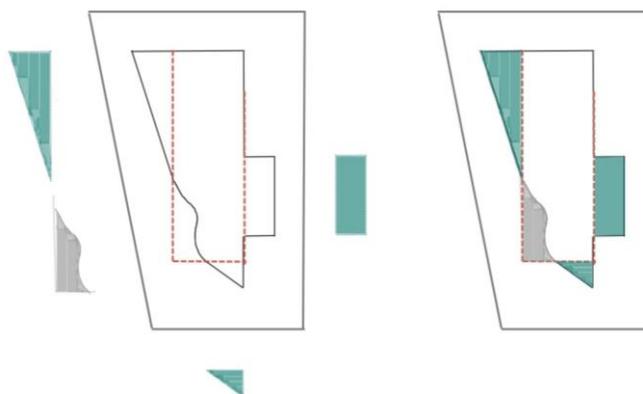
Edifício Hyde Park - subtrações em cinza e adições em azul na planta. Fonte: Adrião, 2024.
